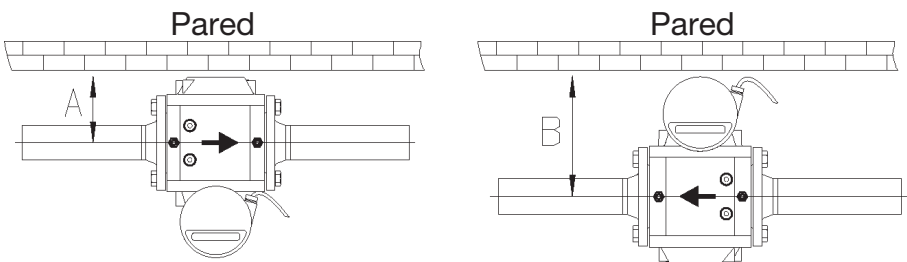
Flujo horizontal, de izquierda a derecha y de derecha a izquierda
